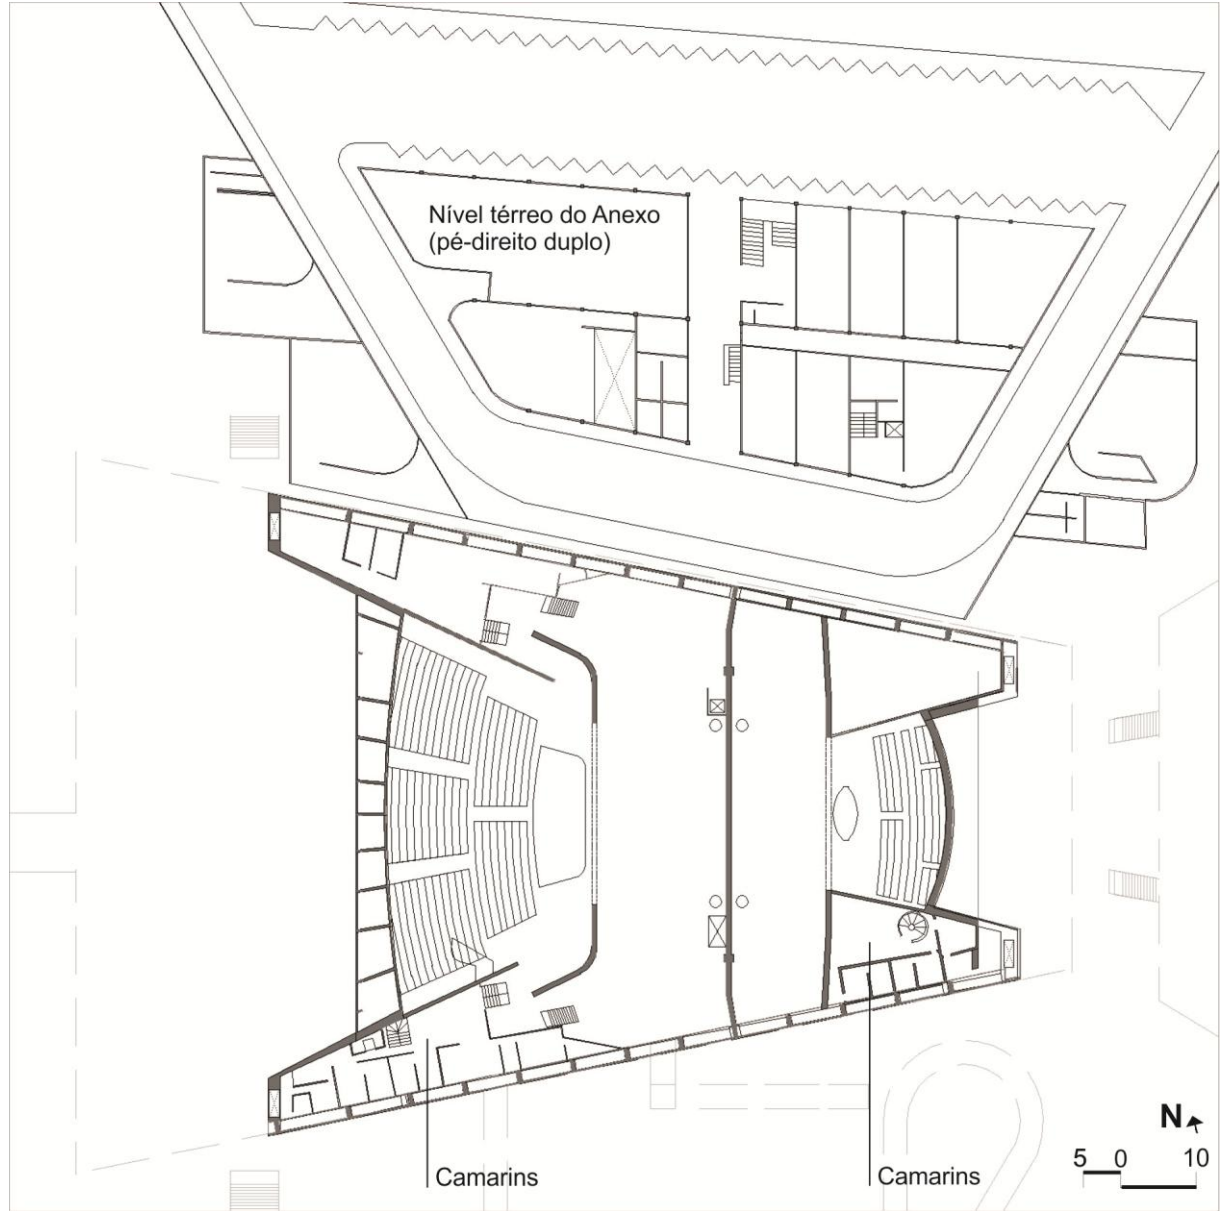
Planta Baixa - Subsolo 2 (-6,40 m).
